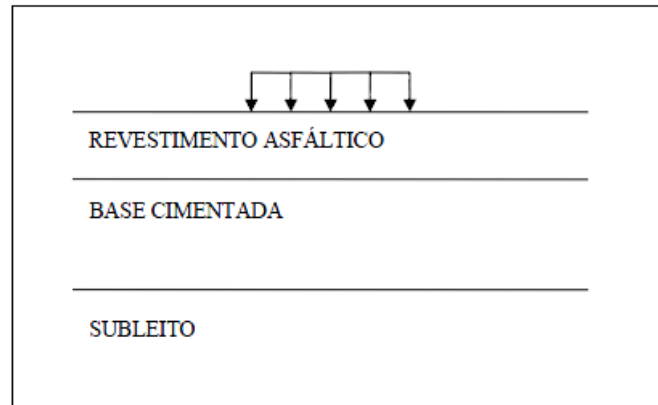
Perfil da Seção Típica de um Pavimento Semi-Rígido.
